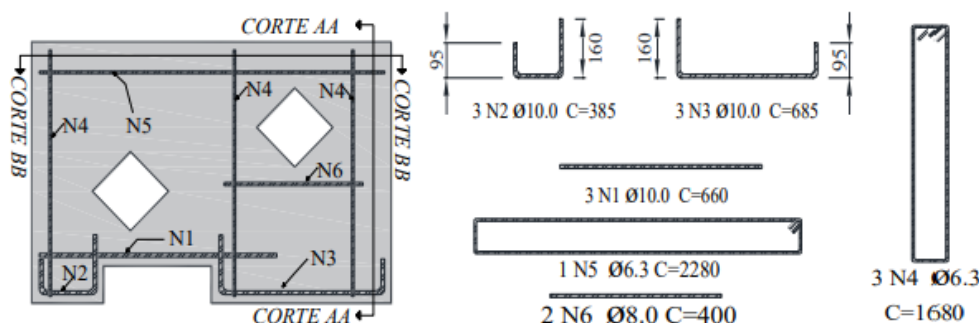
Detalhamento das armaduras DB-WR-H2-NA (dimensões em mm). Neta (2019).
